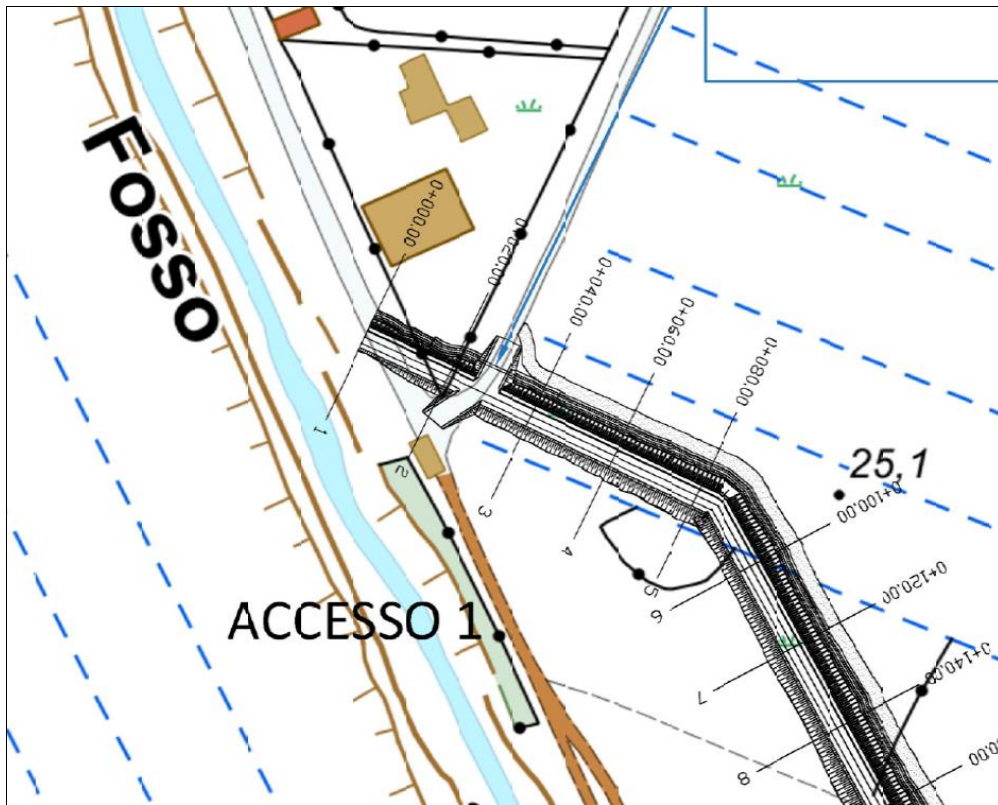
Planimetria di progetto argine Comune di Capena, sez.1-5
